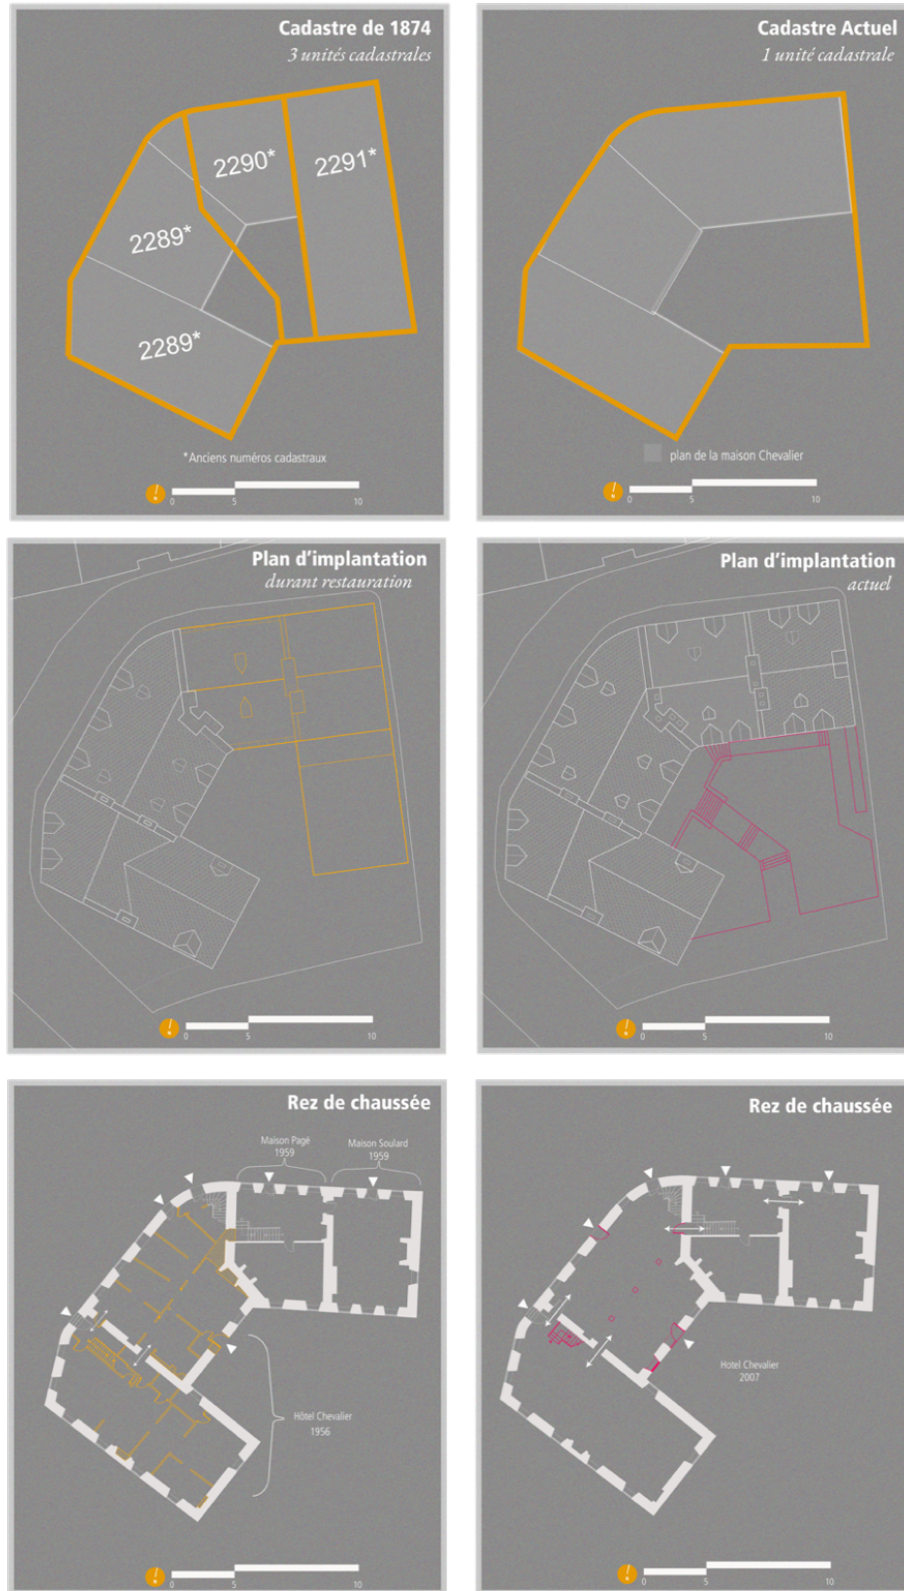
Cadastre, plan d'implantation et plan du RDC de l'ensemble des maisons Chevalier, avant et après restauration.
